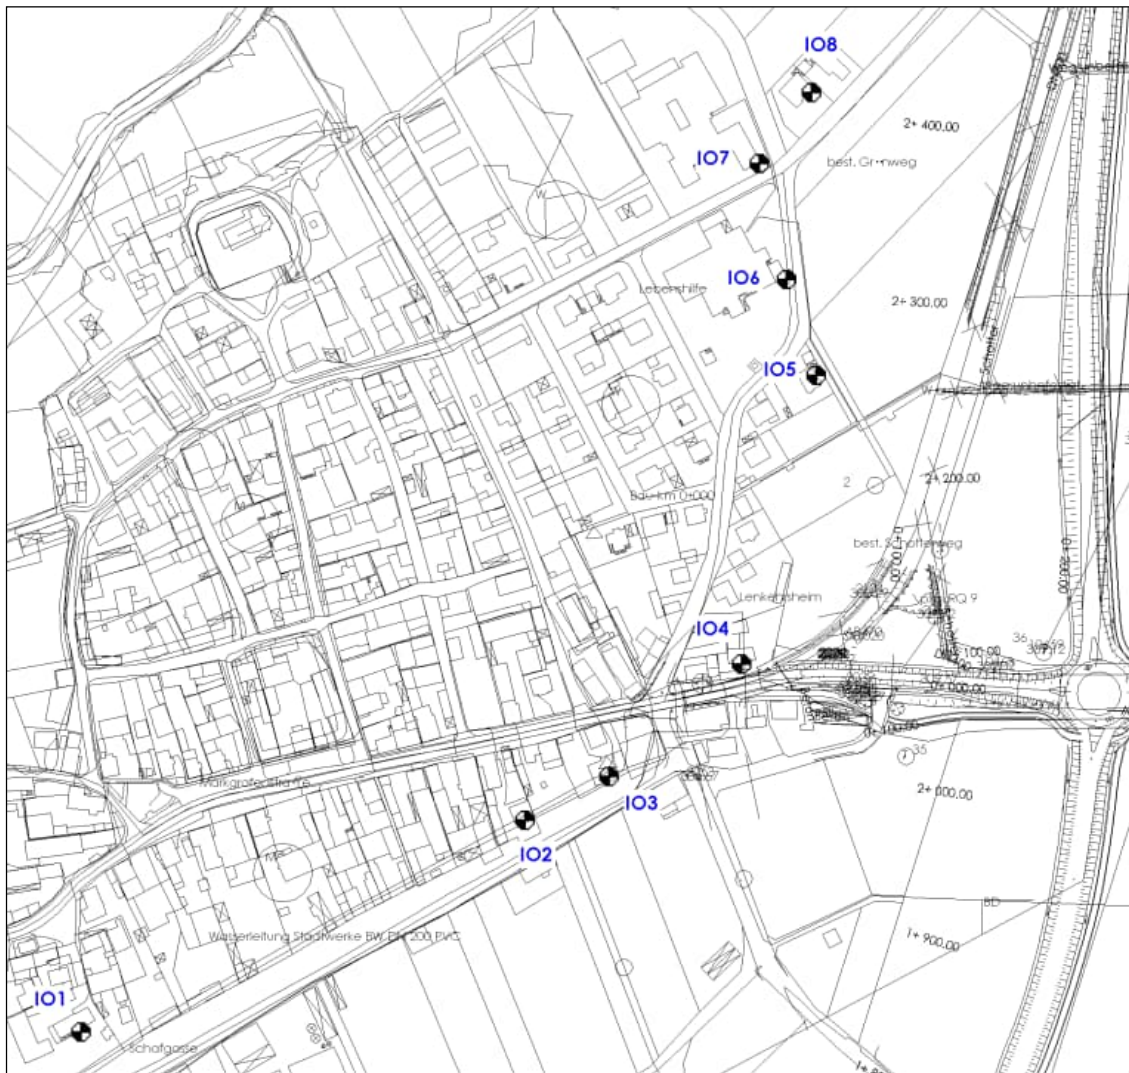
Lageplan mit Darstellung der maßgeblichen Immissionsorte (IO)
